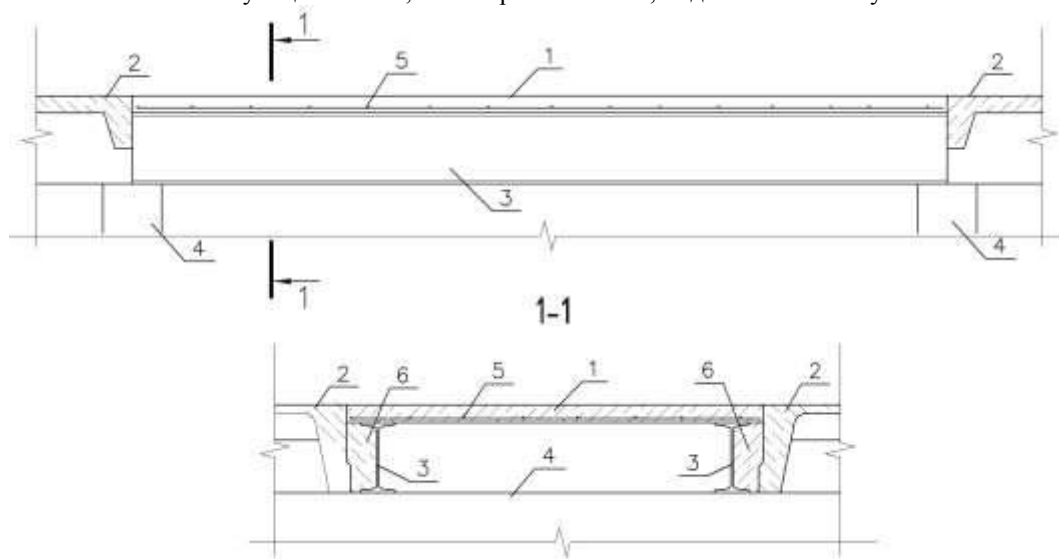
Устройство многослойной железобетонной плиты по металлическим балкам.
